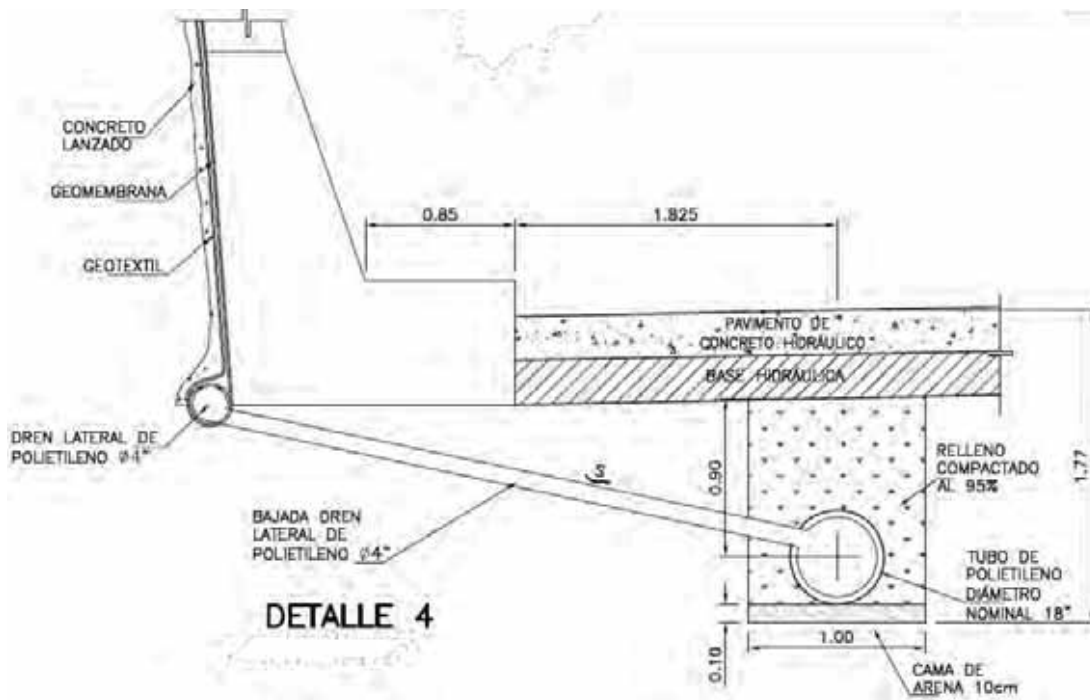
Detalle geomembrana, bajada de agua. S/E Acot. en metros
